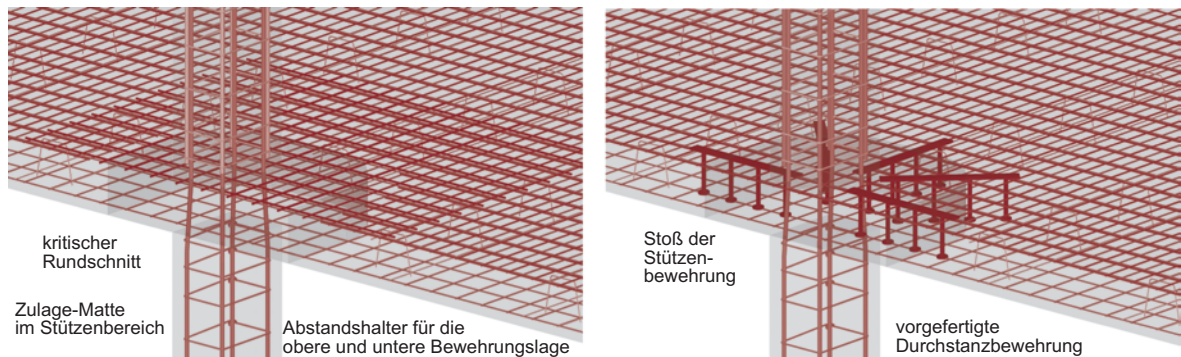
Ausführung der Deckenbewehrung (Durchstanzen) im Bereich einer durchgehenden Stahlbetonstütze
